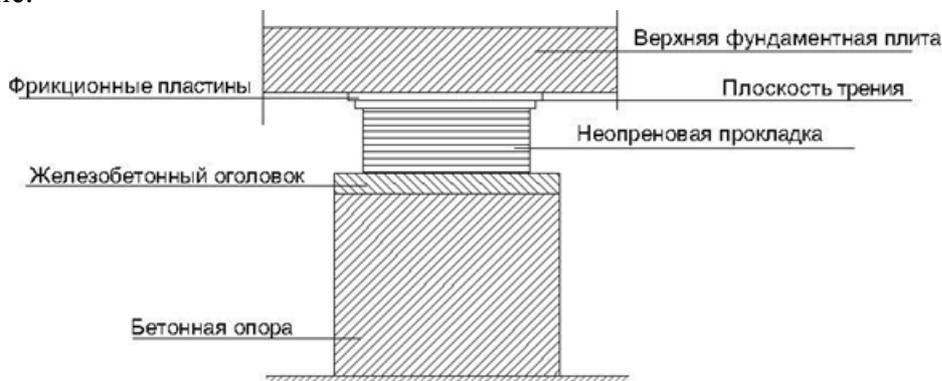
Сейсмоизолирующий фундамент фирмы Spie Batignolle
